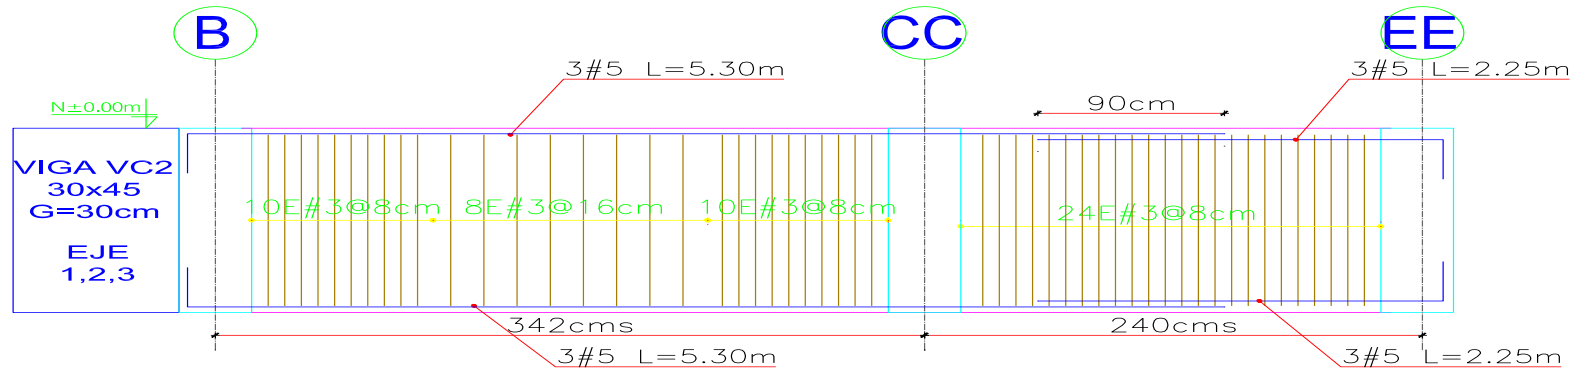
DESPIECE VIGA DE CIMENTACION VC2 EJE 1, 2, 3 N 0,00m.
